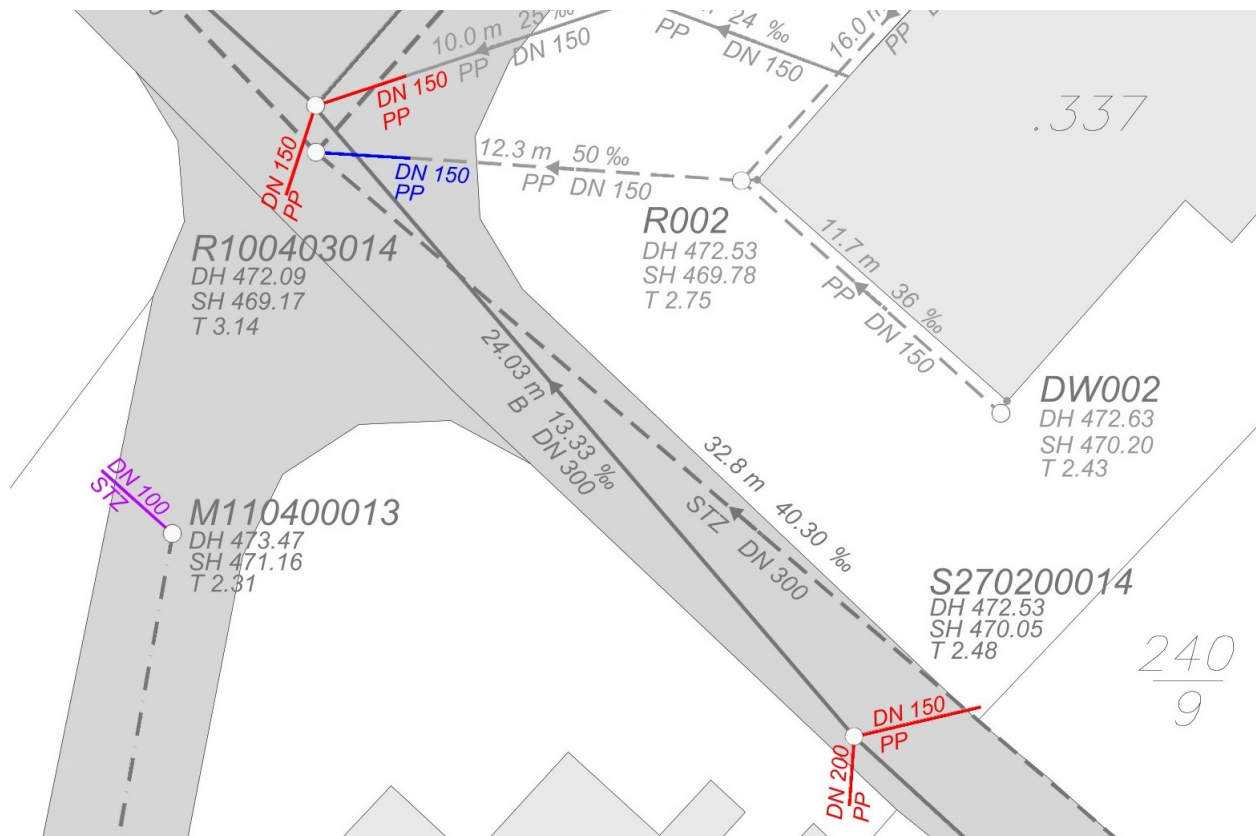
Lageplan – Anschlussstutzen hervorgehoben
